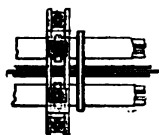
Plan des conducteurs et de leur suspension (tunnel de Baltimore).
